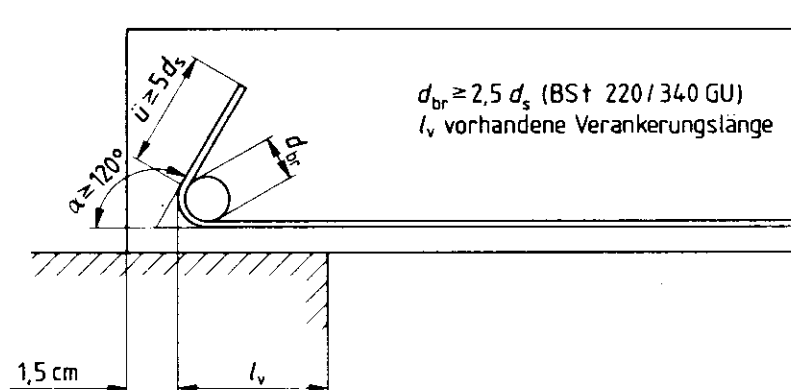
Endverankerung der Hauptbewehrung von Dach- und Deckenplatten am Auflager nach Abschnitt 9.4
